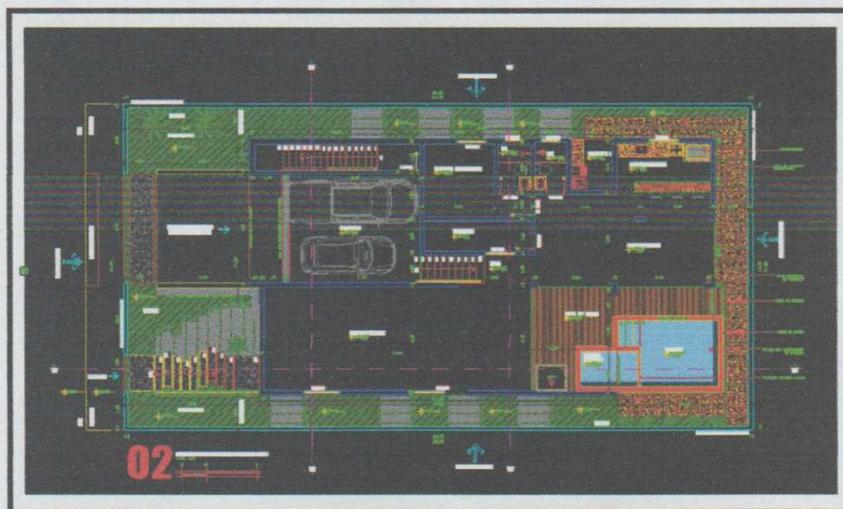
Desenvolvimento de planta baixa utilizando a ferramenta CAD
